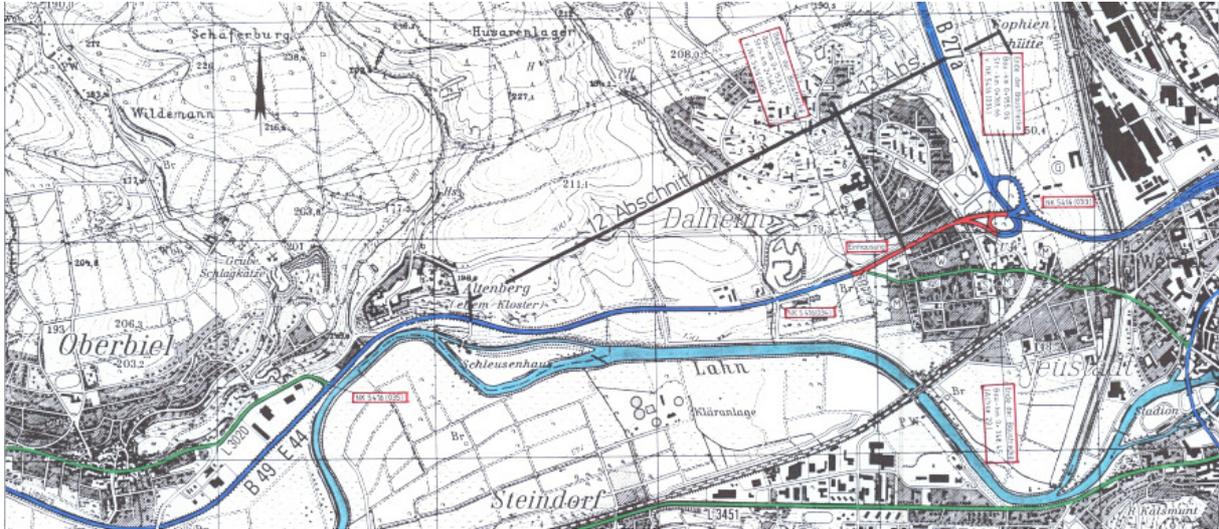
Übersichtslageplan des 13. Abschnitts - M 1:10.000
